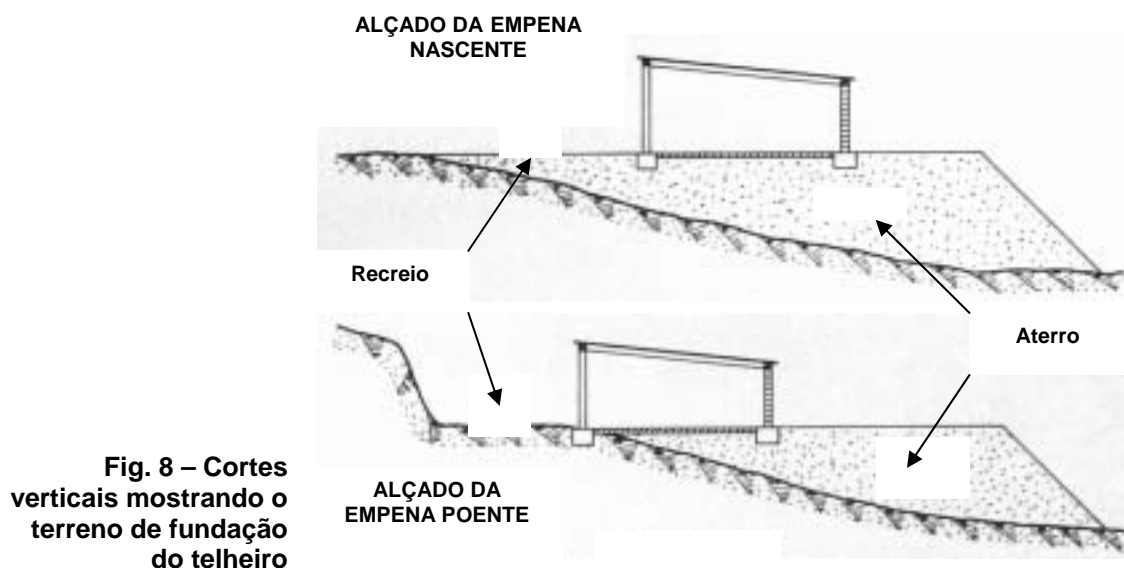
Cortes verticais mostrando o terreno de fundação do telheiro
